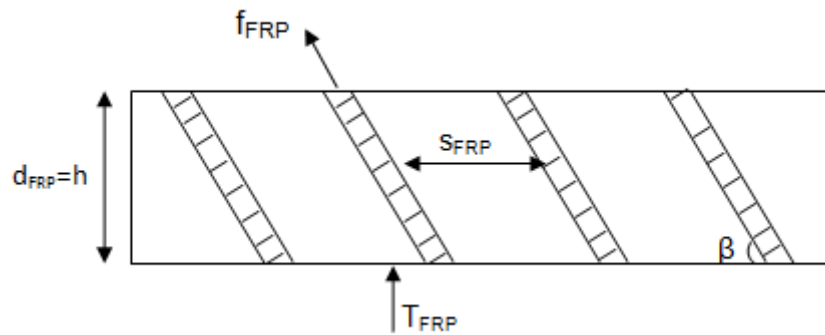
Géométrie d'une section transversale d'une poutre en béton armée renforcée en cisaillement par bandes en composites FRP
